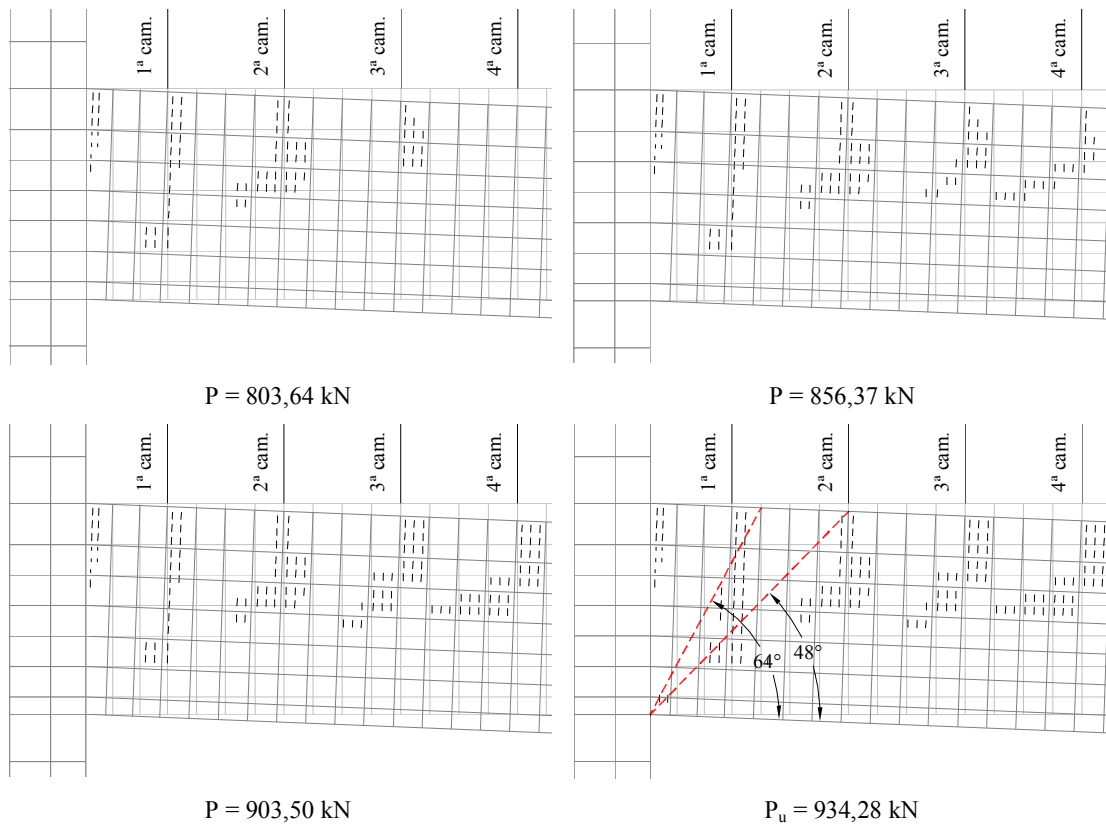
Avanço da fissuração da laje em função da carga aplicada
